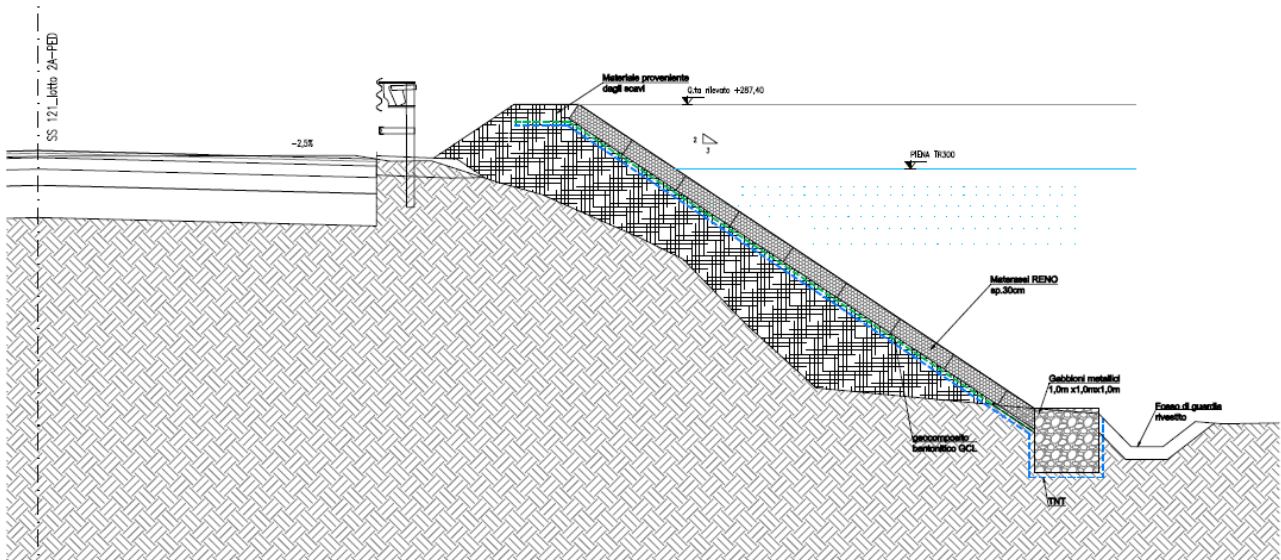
Sezione tipologica di sistemazione dell'argine sulla viabilità principale
